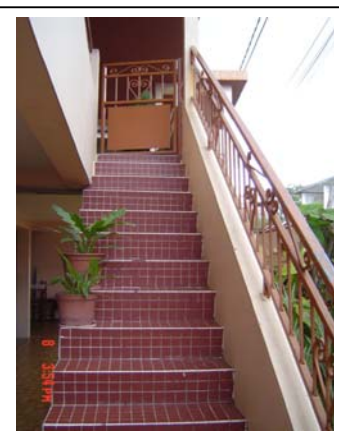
carrelage simple, Volga Plage (octobre 2004)
